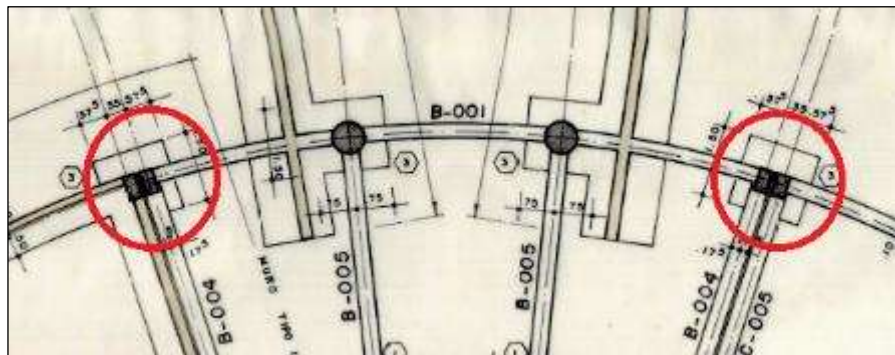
Fuente: autores, (2018), Ubicación elementos 1 y 2 en plano de cimentación Alcaldía Yopal.
